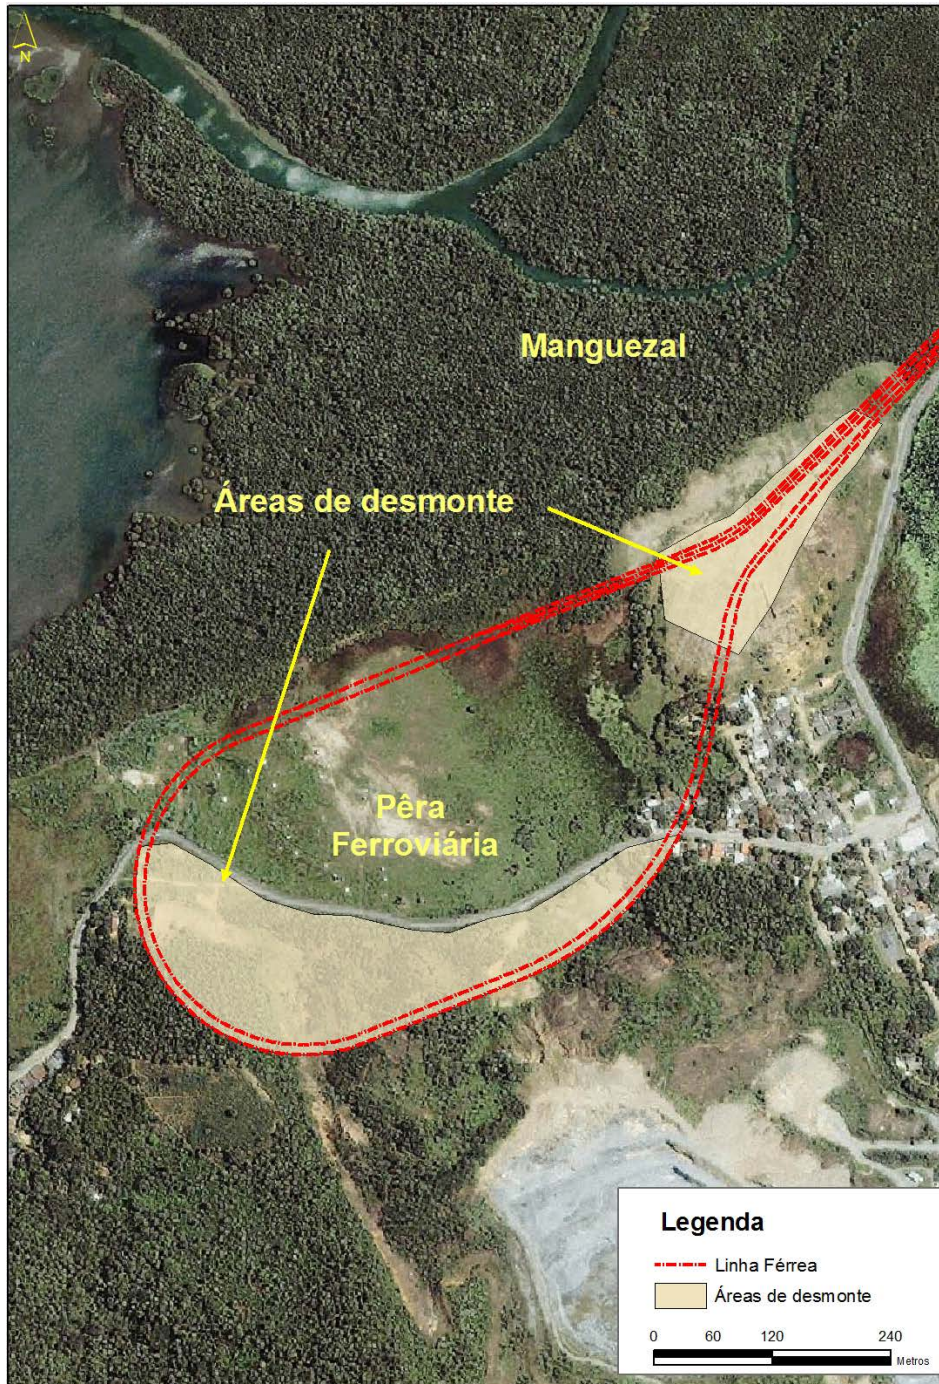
Área destinada à implantação da malha ferroviária que atende o Porto Sudeste
